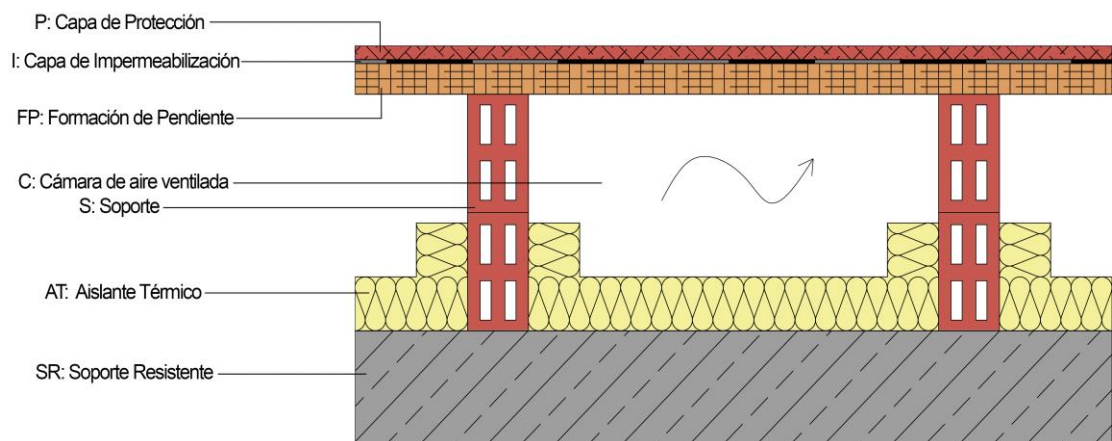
Representación de la cubierta plana convencional con cámara de aire I.
